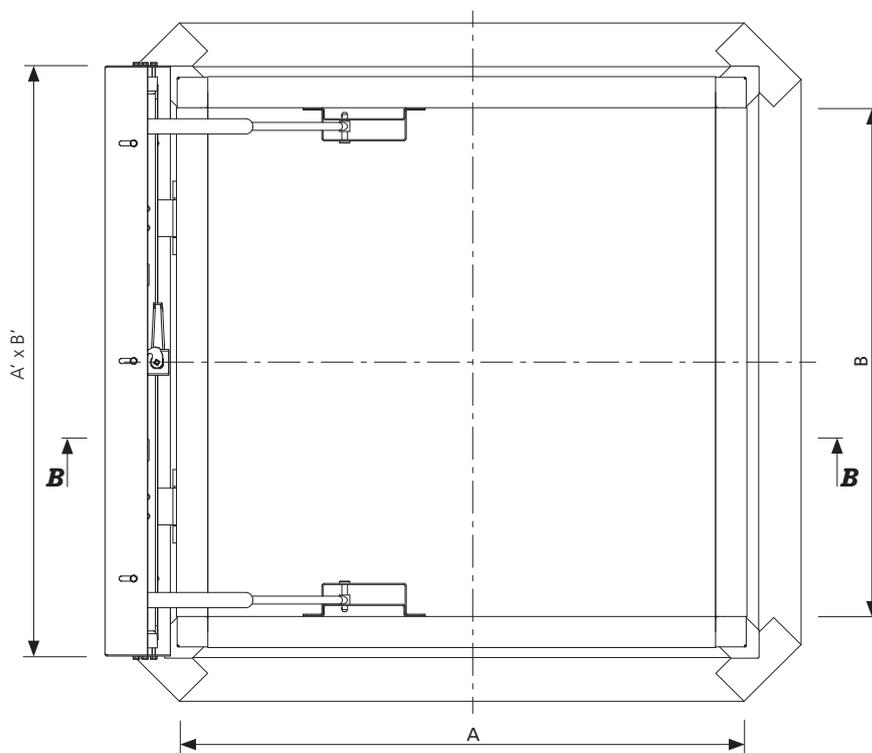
Vue de haut d'un lanterneau d'accès toiture mcr PROLIGHT NG-A en position ouverte, dimensions en mm
